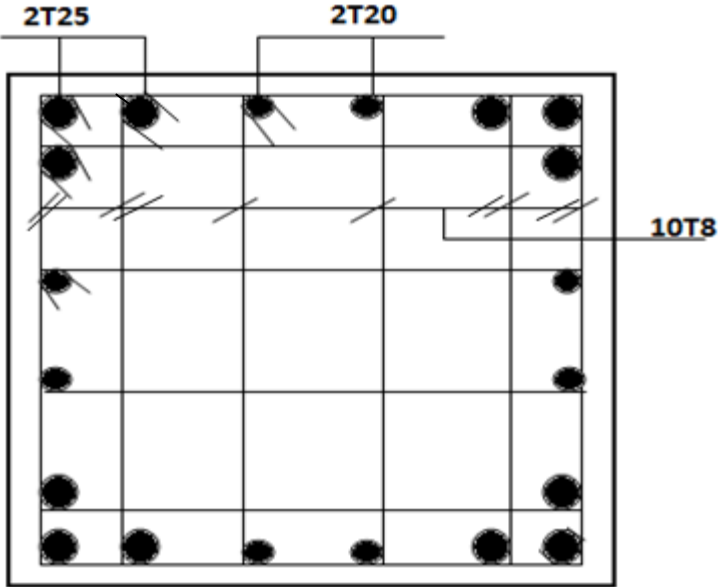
Schéma de ferrailage du poteau 65×65 (relié avec un voile)
